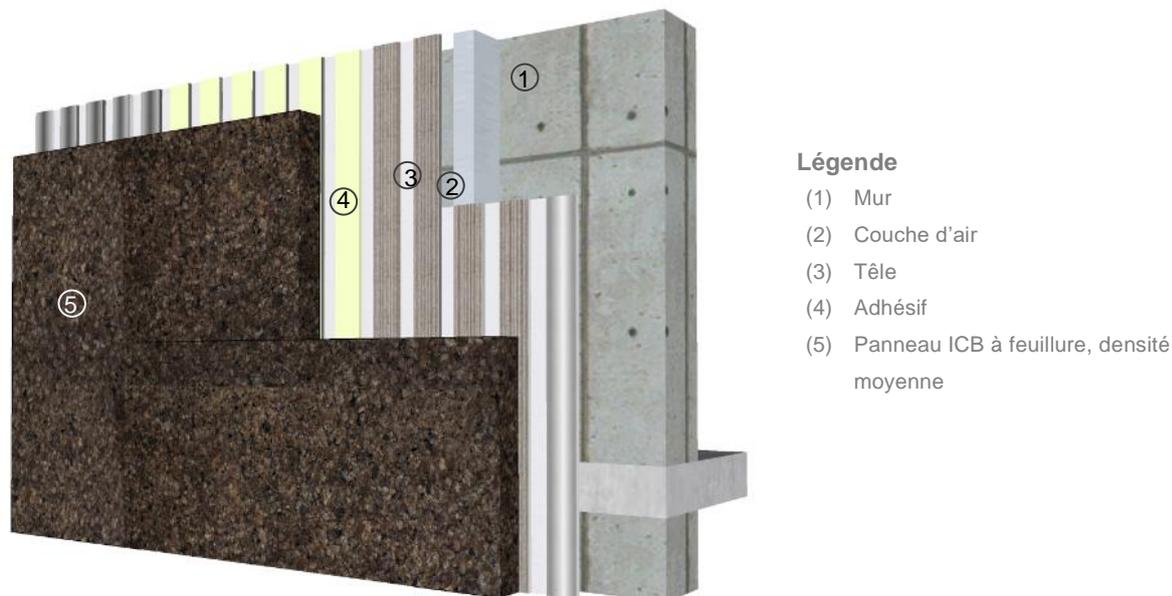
Illustration schématique du système de façade MD sur tôles.
